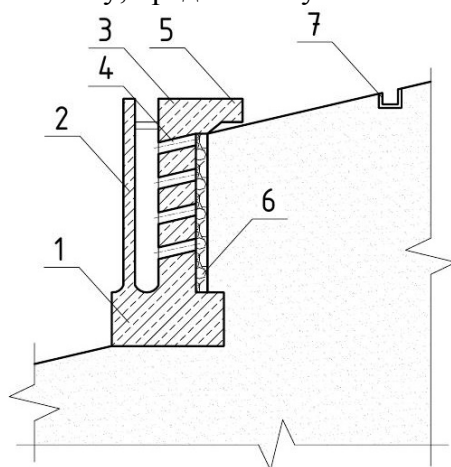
Конструкция фильтрующей железобетонной подпорной стенки [13],
